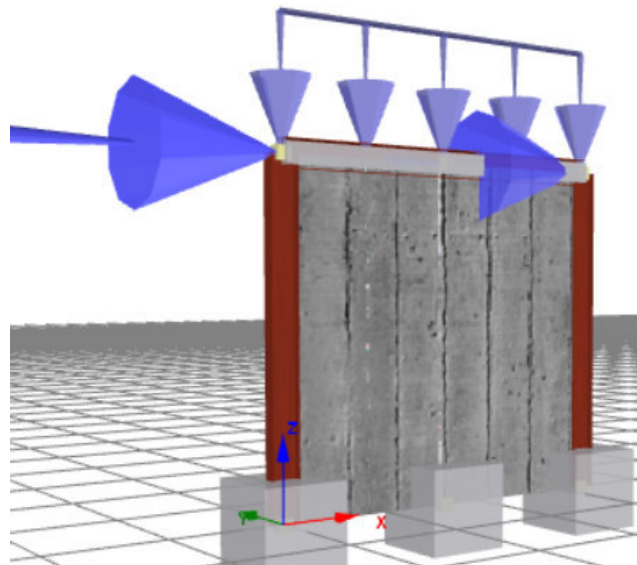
Pórtico enchapado con daño previo moderado en mampostería.
